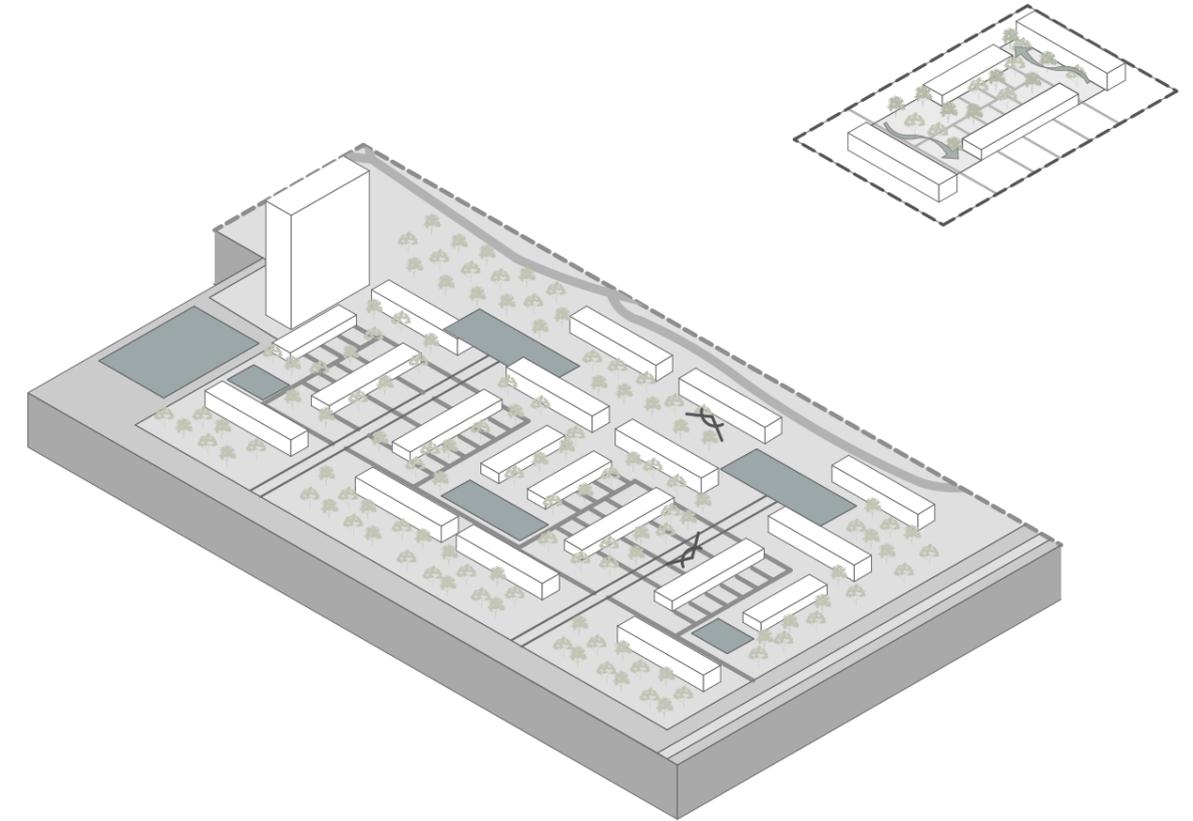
Axonometría de emplazamiento Parque Lafayette. Fuente: Elaboración Propia
